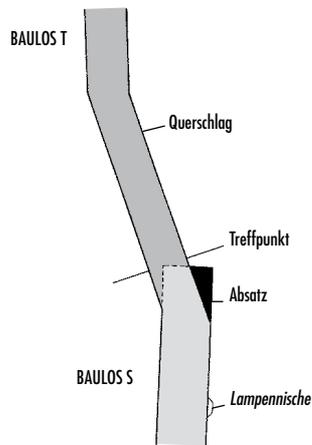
Detail: Treffpunkt Bauolos S und T im Grundriß. M. 1:100.
